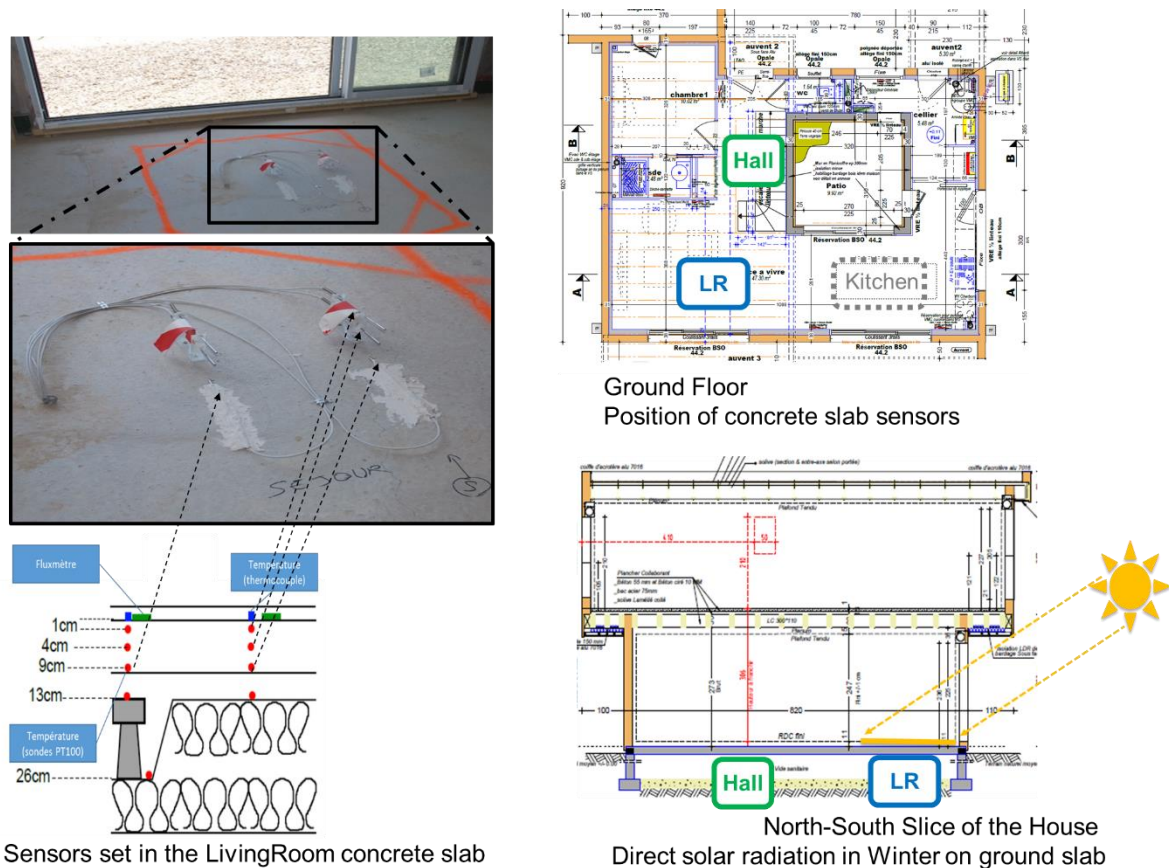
Capteurs intégrés dans la dalle du rez-de-chaussée
